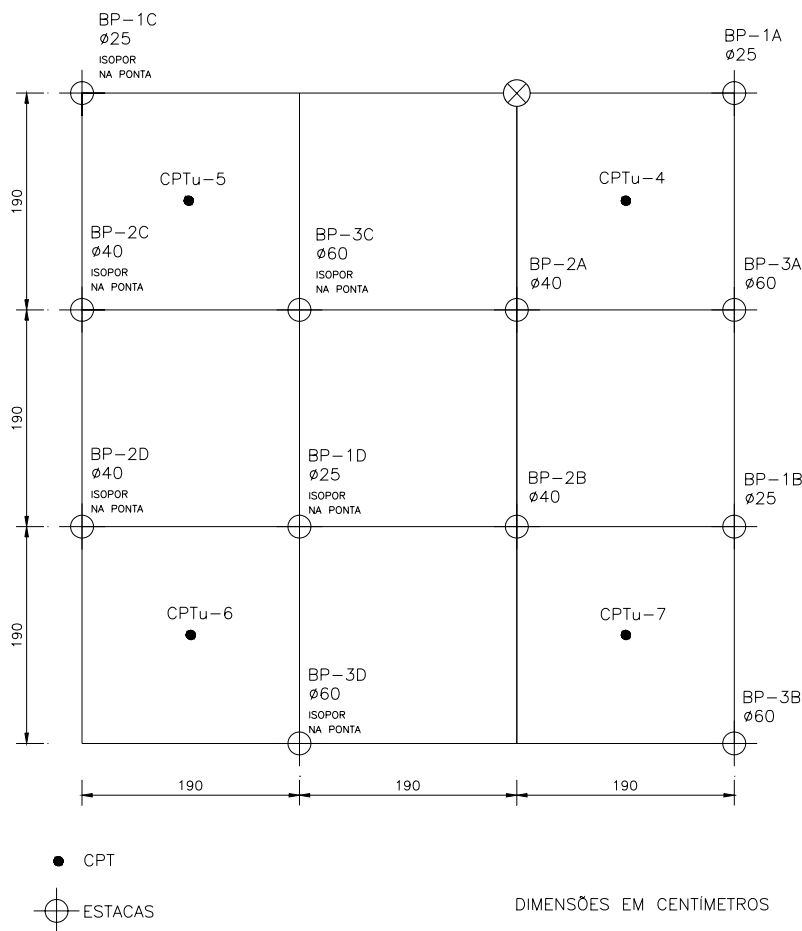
Detalhe da implantação das estacas escavadas mecanicamente – Área 1.
